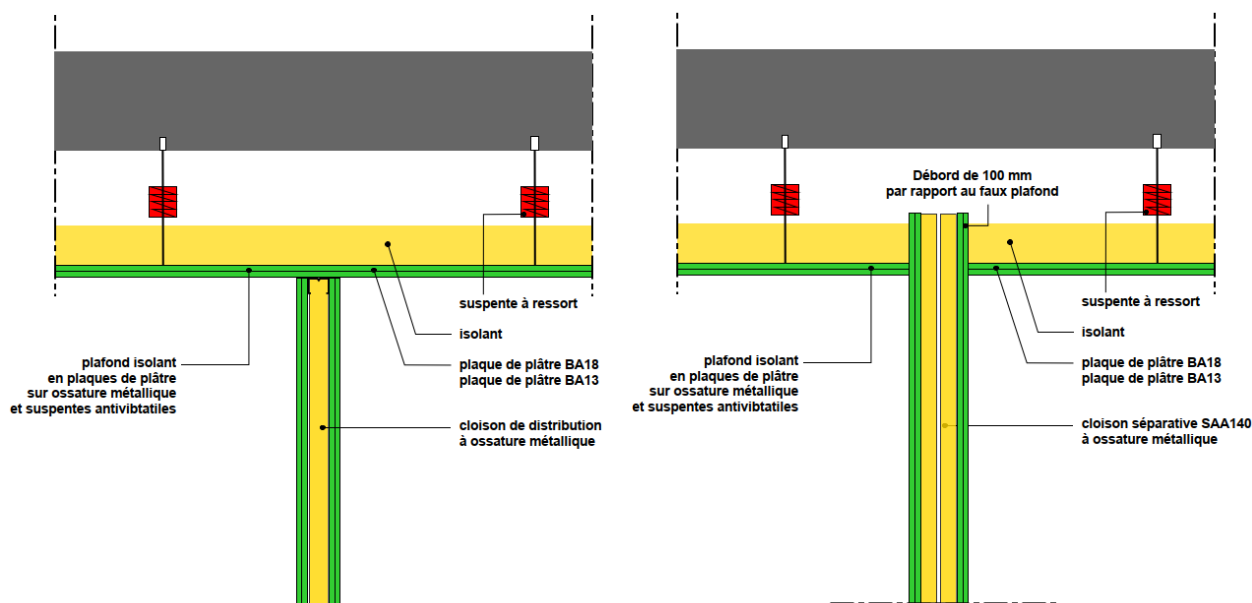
Principe de jonction cloison – plafond isolant sur ressort, en coupe verticale
